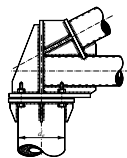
Опорный узел центрифугированной трубобетонной фермы
